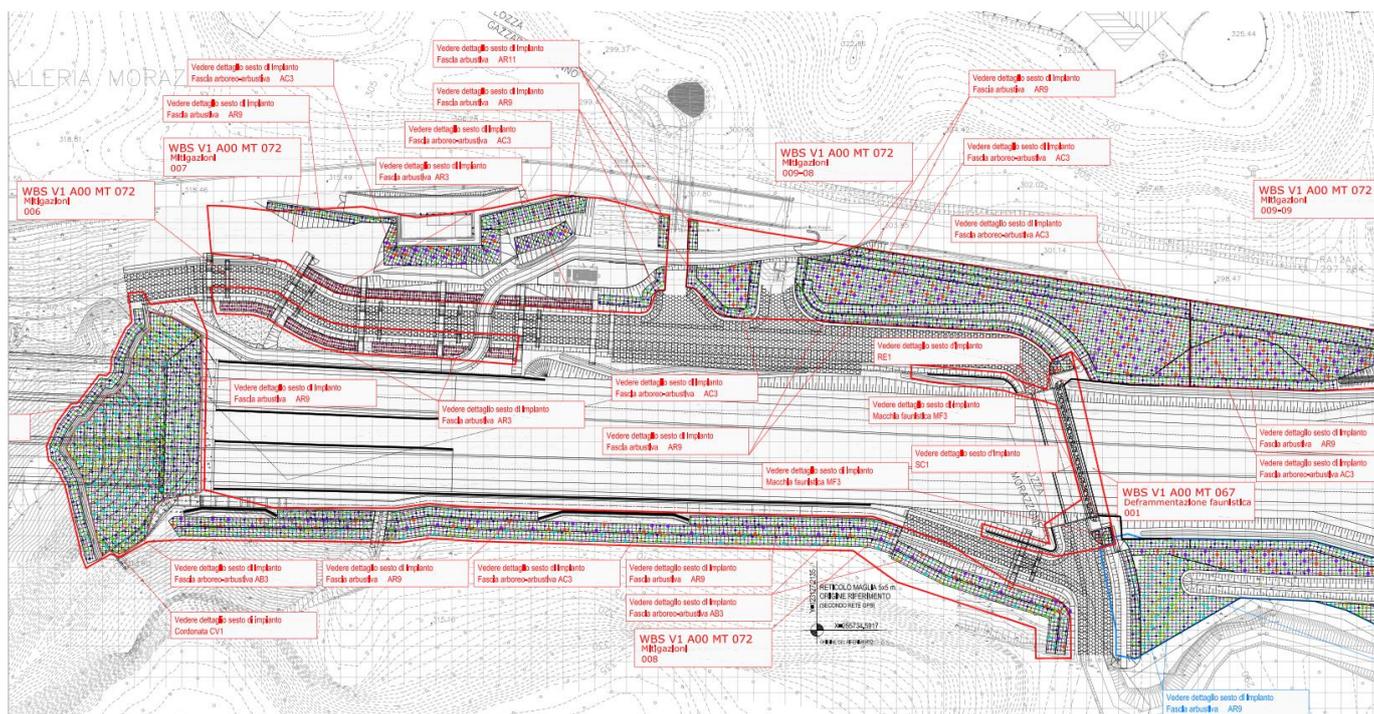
planimetria as built delle mitigazioni a verde nell'area del torrente La Selvagna
